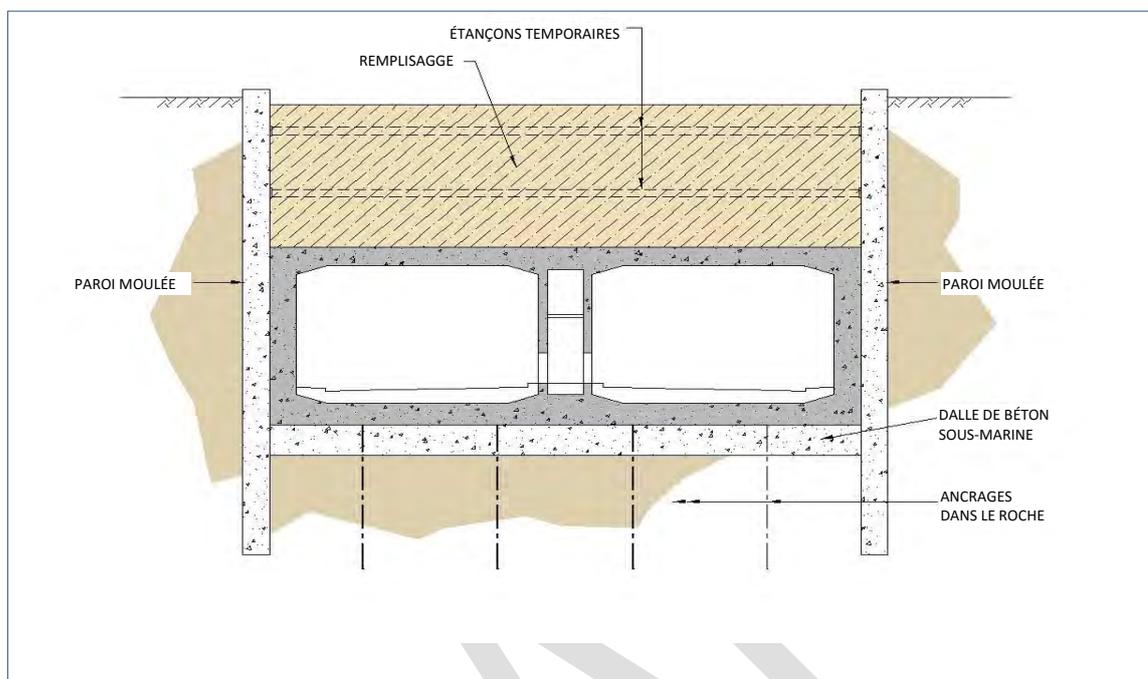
Section transversale type pour la tranchée couverte utilisant les parois moulées
